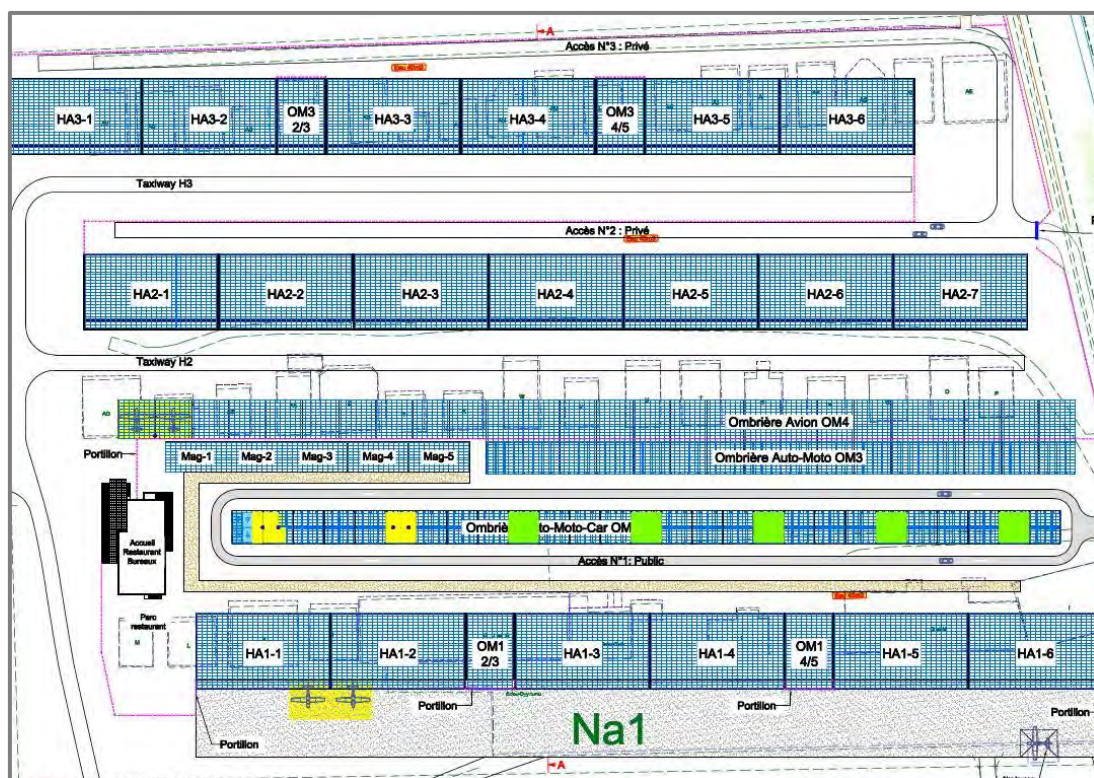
Plan de masse de la variante finale (septembre 2021)
